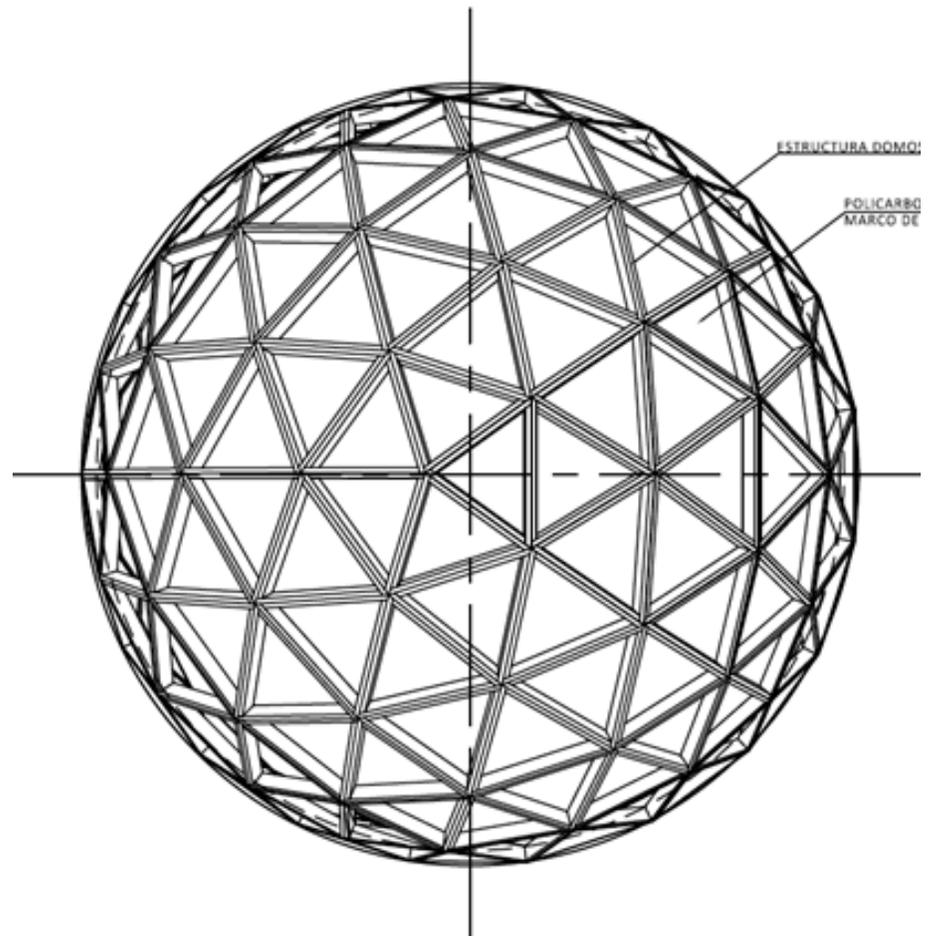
Planta de techumbre vivienda ecológica “Aka Pacha” con bloques de sal labrada a nivel
